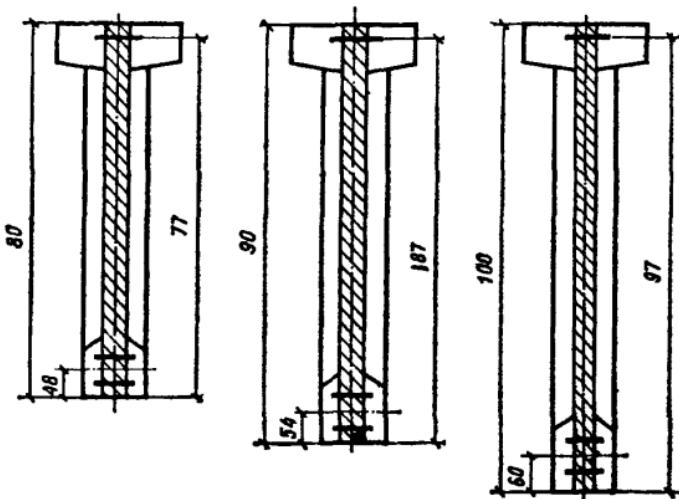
Варианты сечения двутавровой самонапряженной балки с механическим напряжением продольной арматуры
